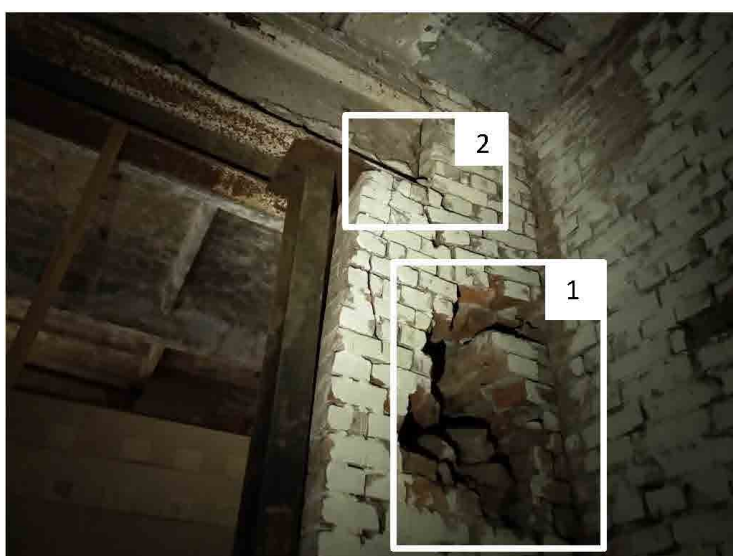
Дефекты: 1- разрушение кладки (выпадение кирпичей); 2- сквозная трещина в месте опирания балки.
